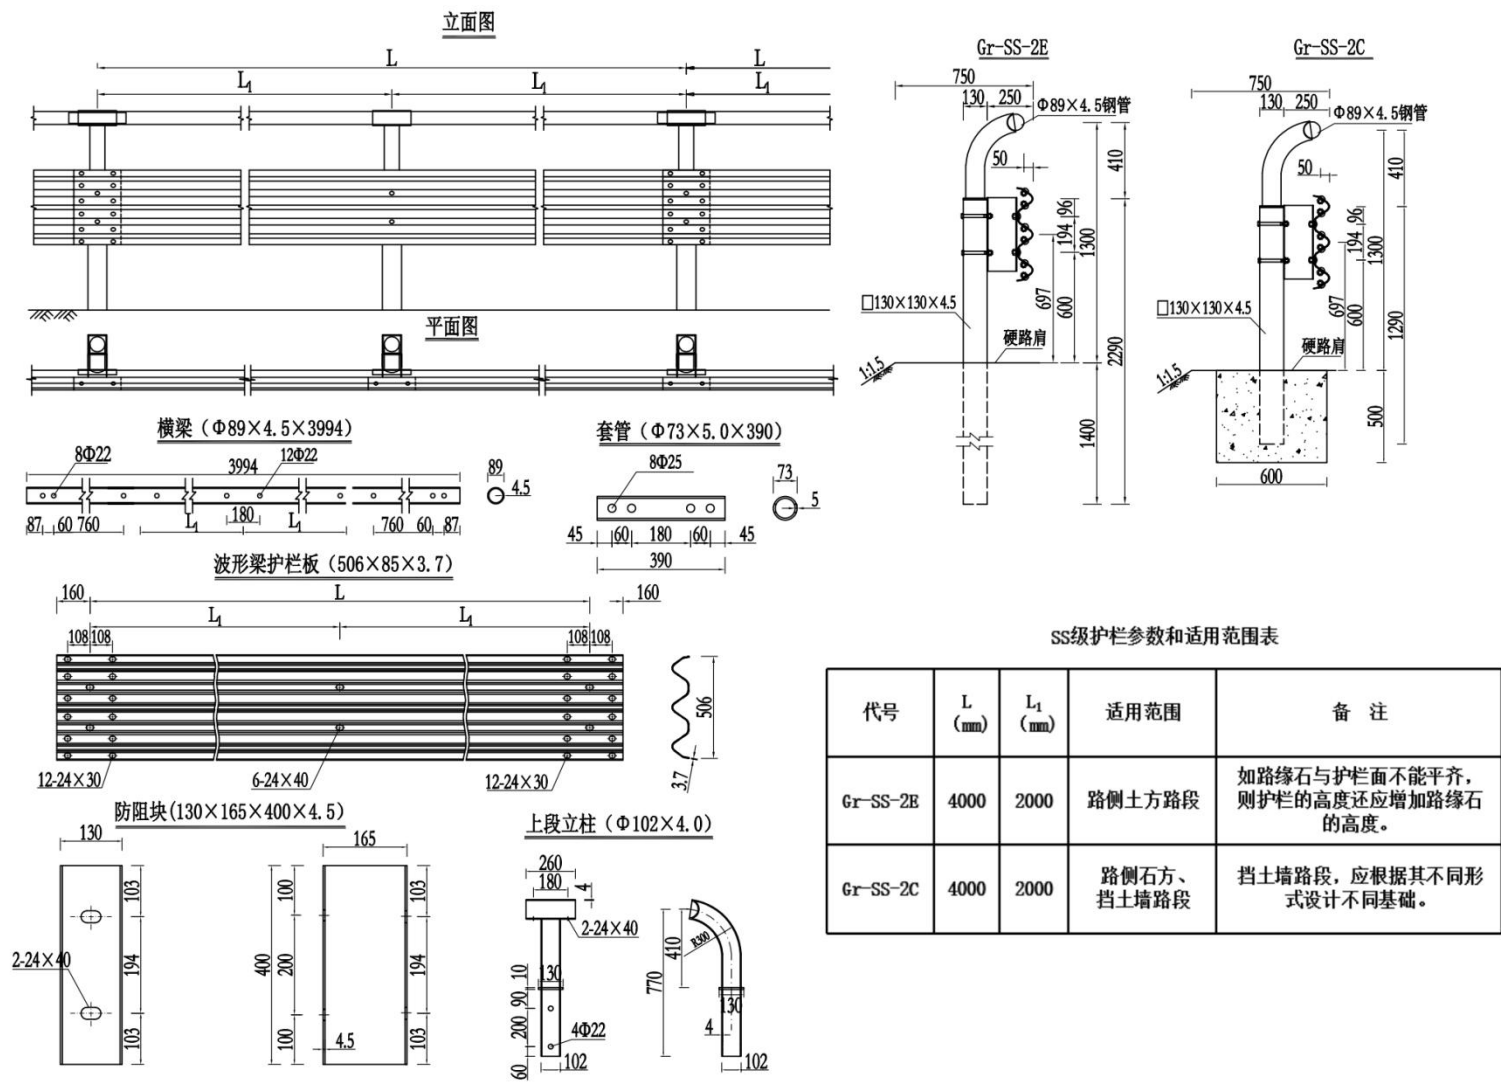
六 (SS) 级不锈钢护栏一般构造示例 (尺寸单位: mm)
